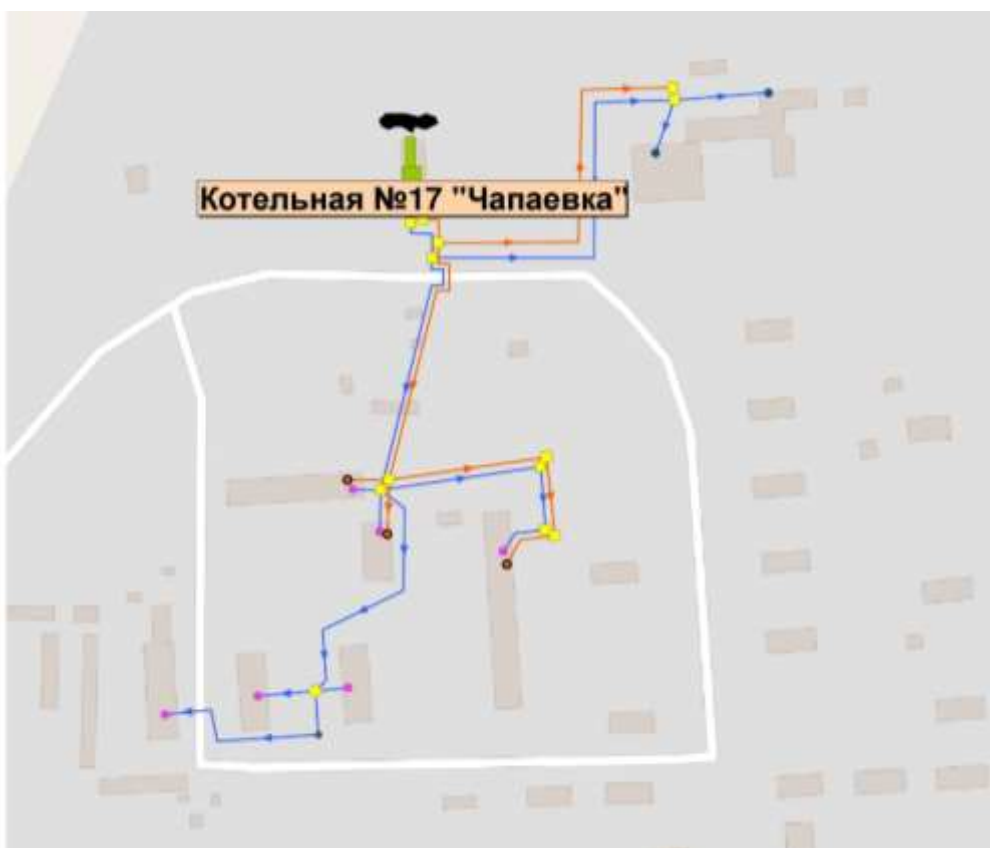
Схема тепловых сетей от котельной №17
